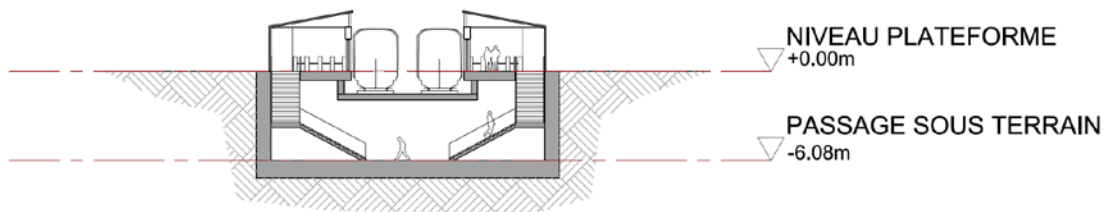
Croquis - coupe transversale - station projetée au niveau du sol
